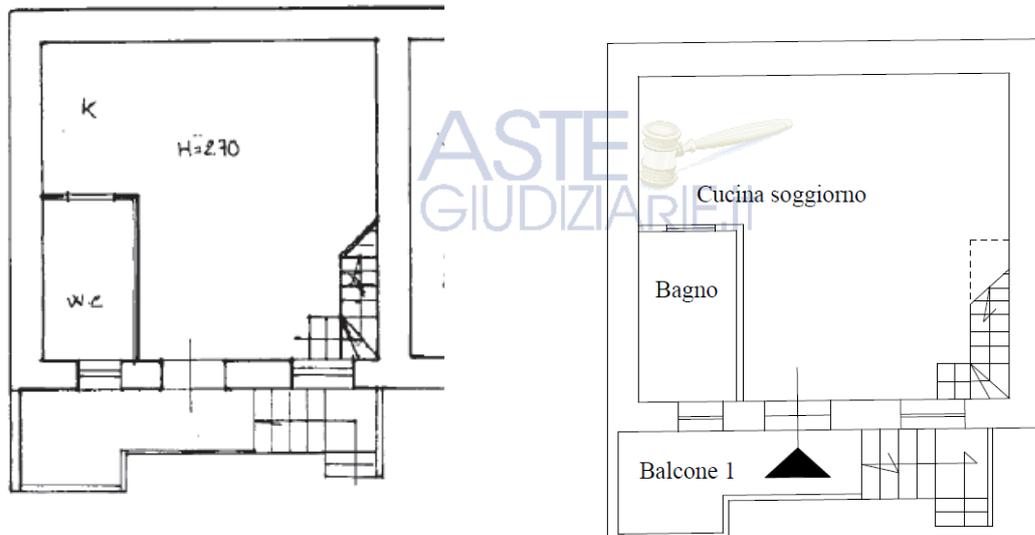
Planimetria catastale degli immobili al piano rialzato e grafico dei beni all'attualità.
